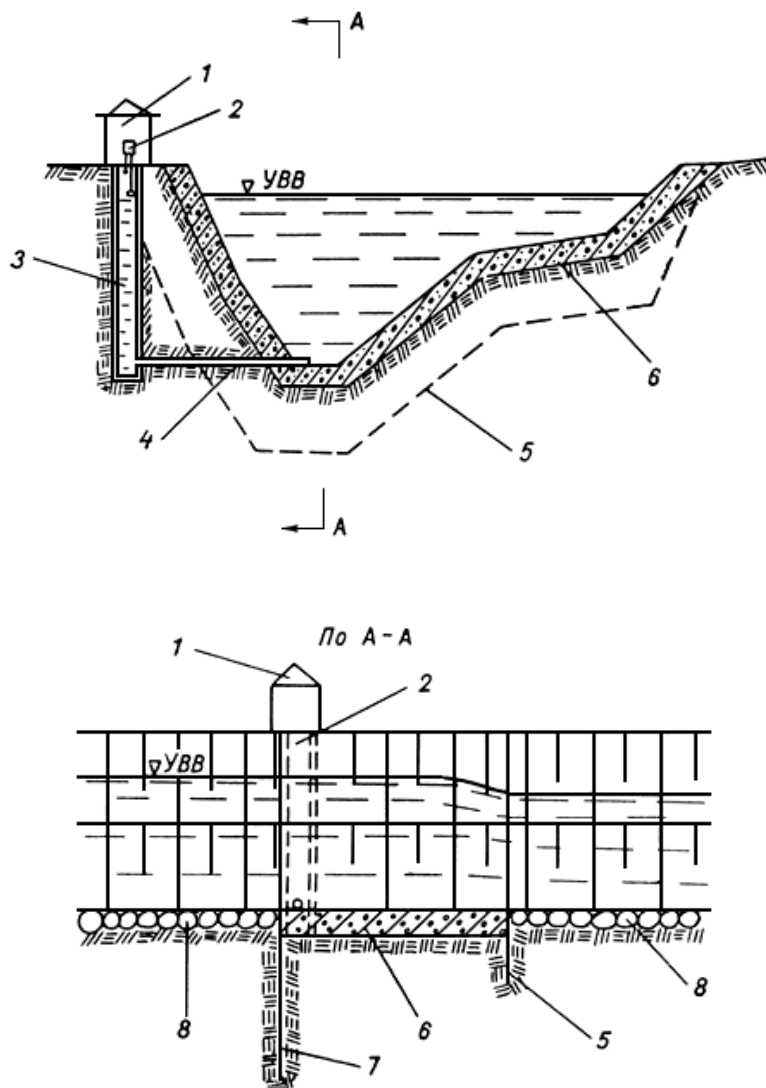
Контрольное русло со сплошным бетонным креплением смоченного периметра
